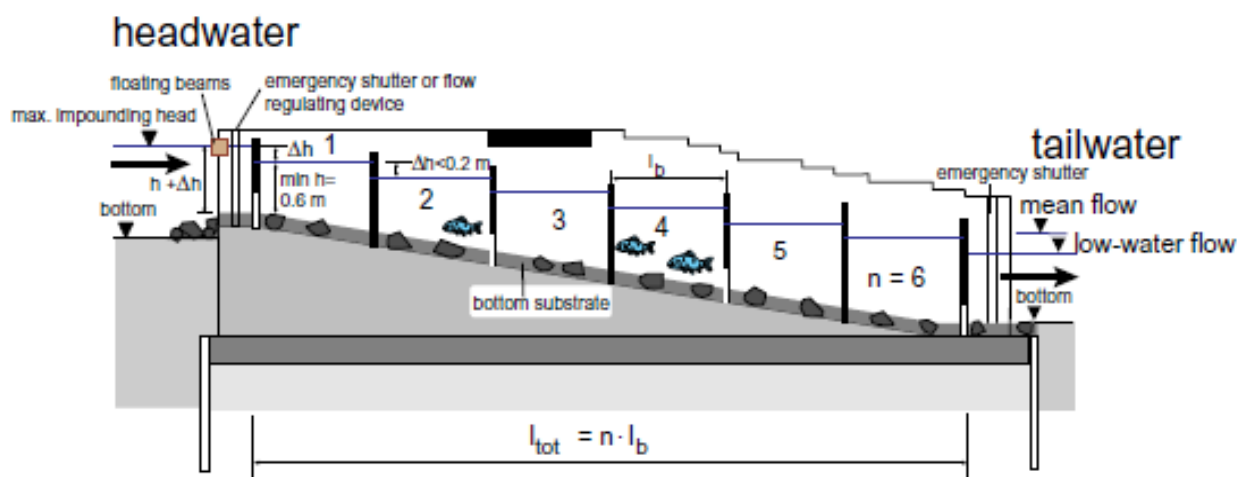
SEZIONE SCHEMATICA LONGITUDINALE DI PASSAGGIO A VASCHE.
